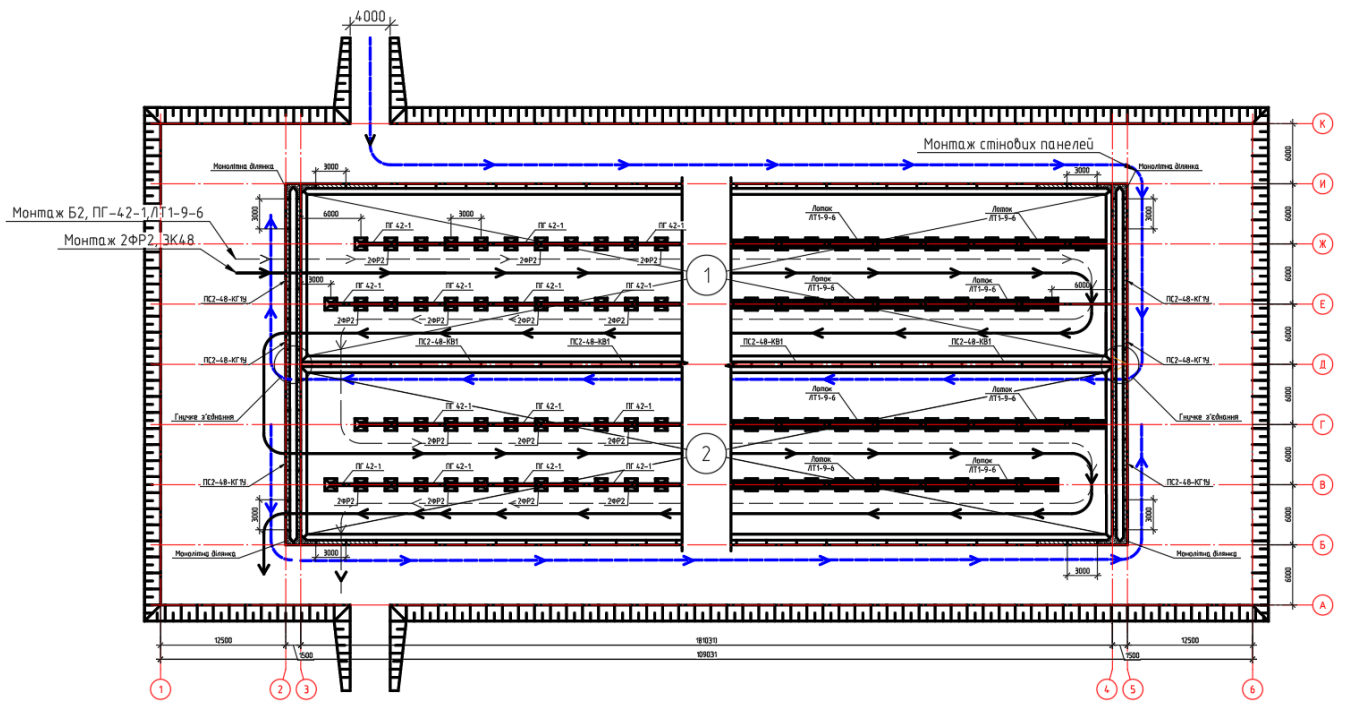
Схематичний план аеротенка з маркуванням конструкцій каркаса
